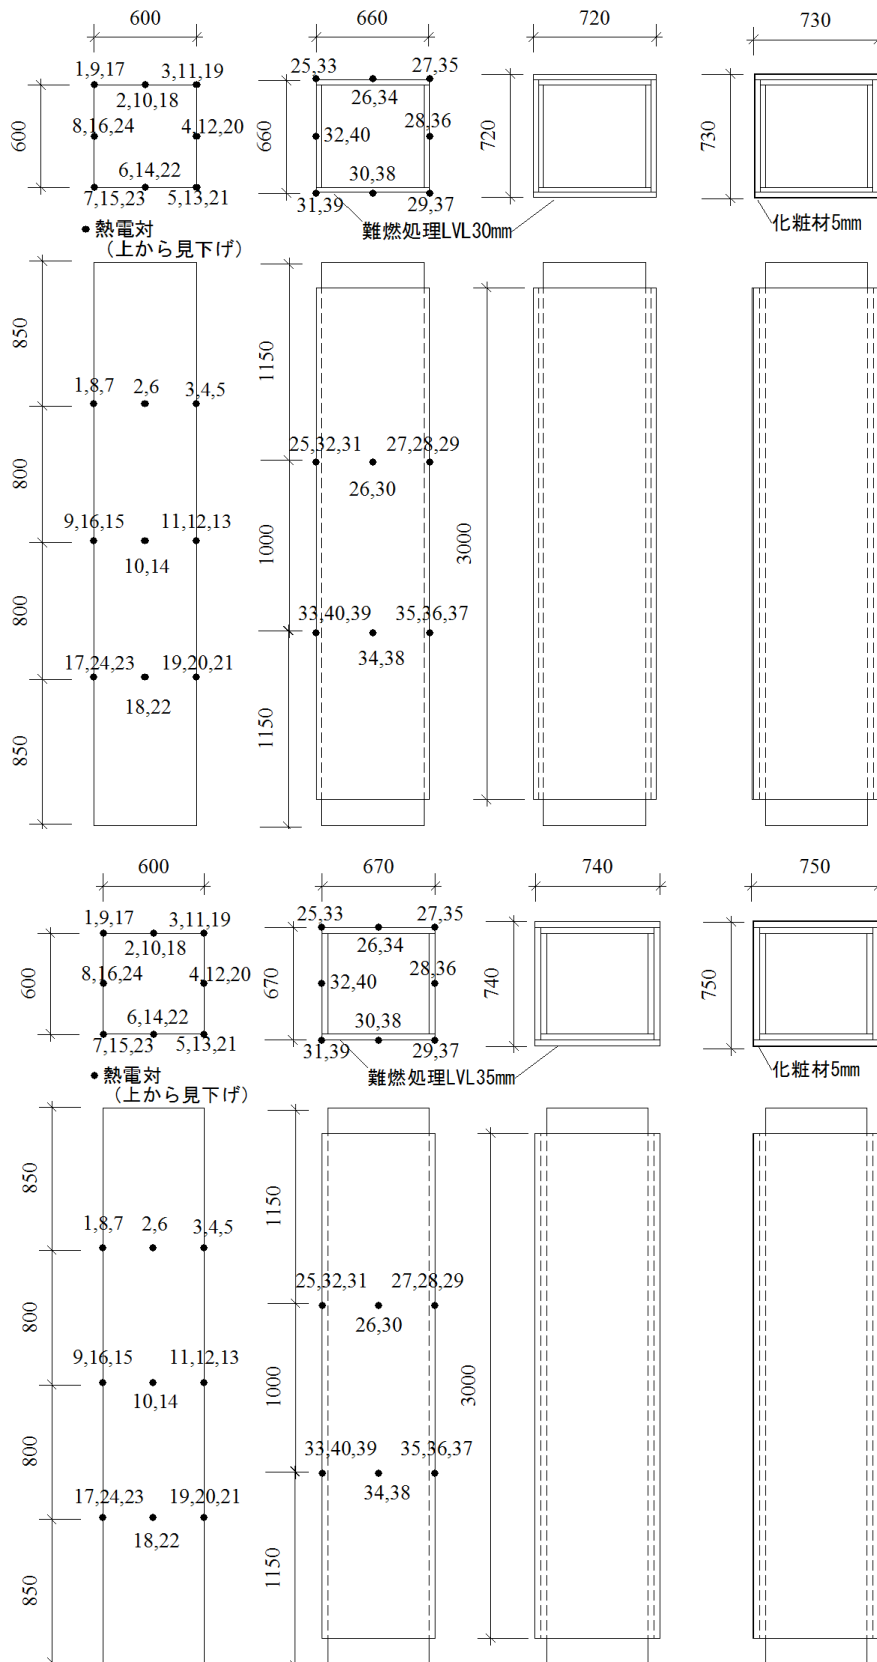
試験体平面図および断面図、熱電対位置 (上:L250C_60、下:L300C_70)
